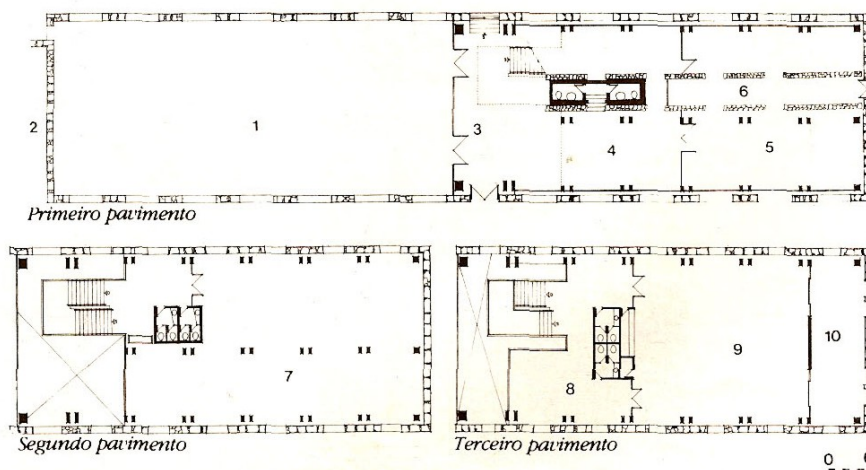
Planta Primeiro e Segundo pavimento-estrutura independente.
